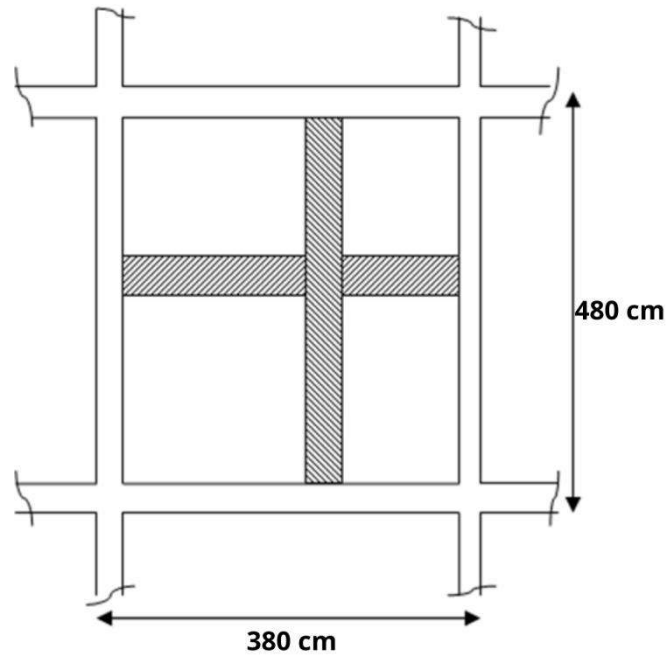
Dimension du panneau de dalle le plus sollicité
